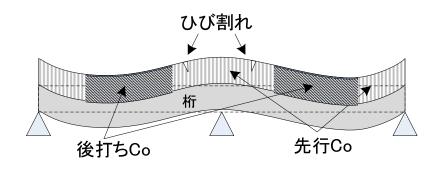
誤った床版コンクリートの打設順序によるひび割れイメージ
